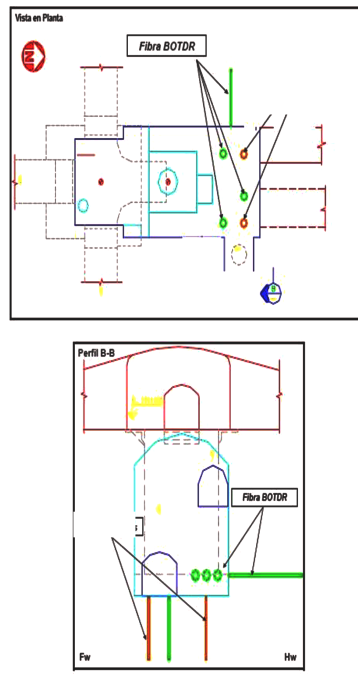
Instrumentación en piso y pared Cámara Chancado Primario.
